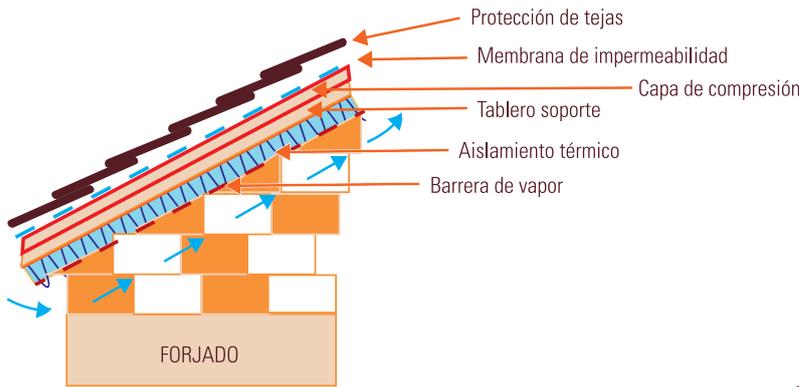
Cubierta fría con aislamiento en cara inferior de faldón
